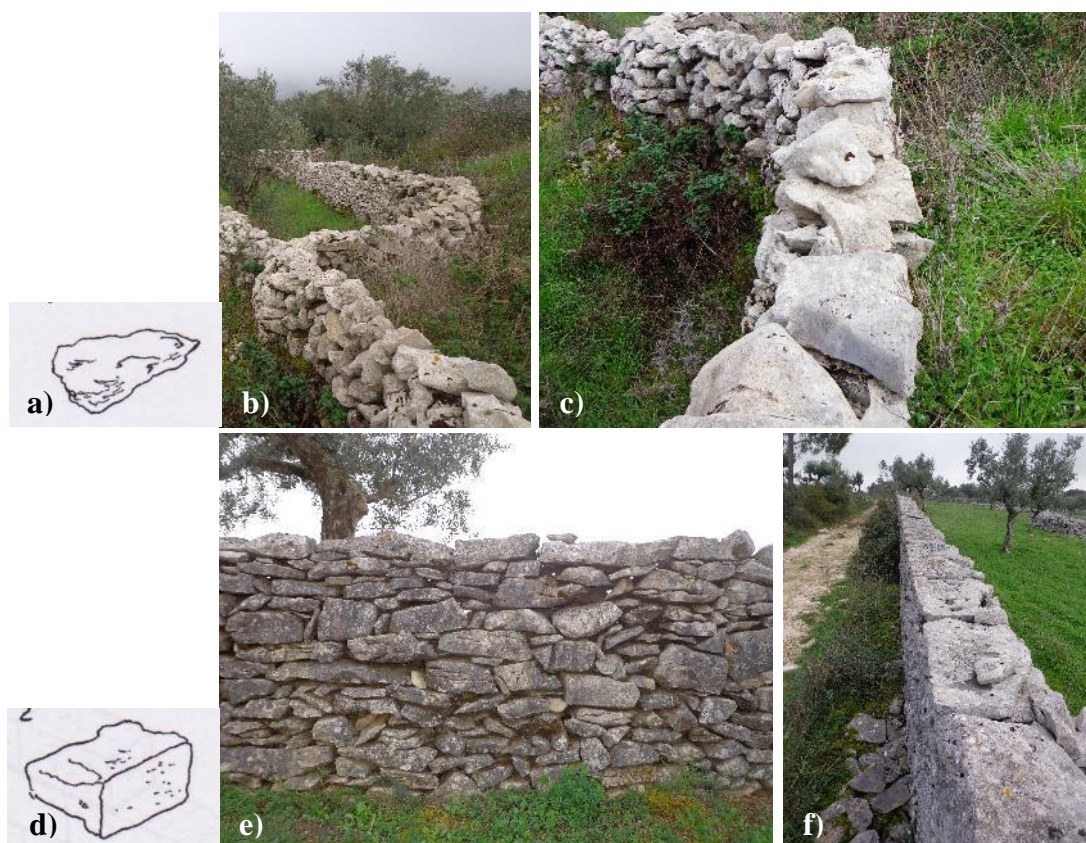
a) Pedra irregular; b) Vista lateral de muro com pedras irregulares; c) Vista superior de muro com pedras irregulares; d) Pedra aparelhada na face exposta; e) Vista lateral de muro aparelhado; f) Vista superior de muro aparelhado numa das faces
